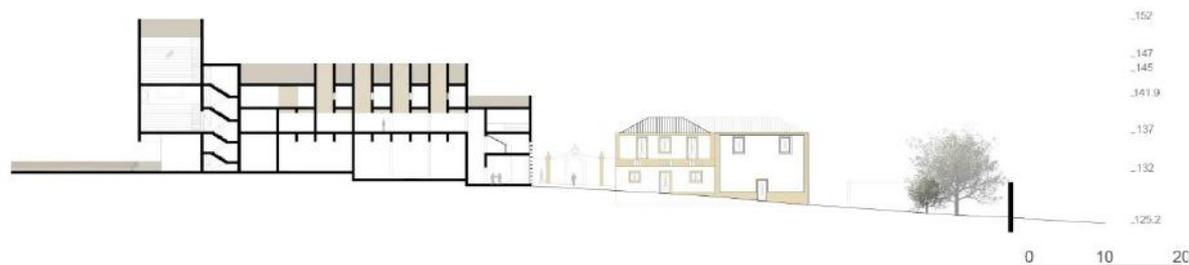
Plano de Pormenor: Corte Longitudinal pelo edifício da cantina
